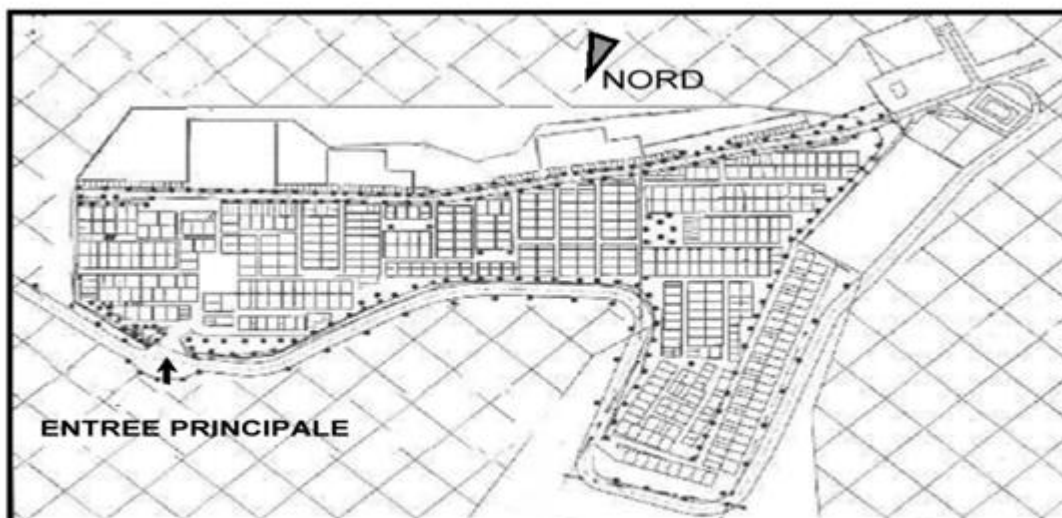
Plan de masse du ksar Tafilelt : plan en damier
